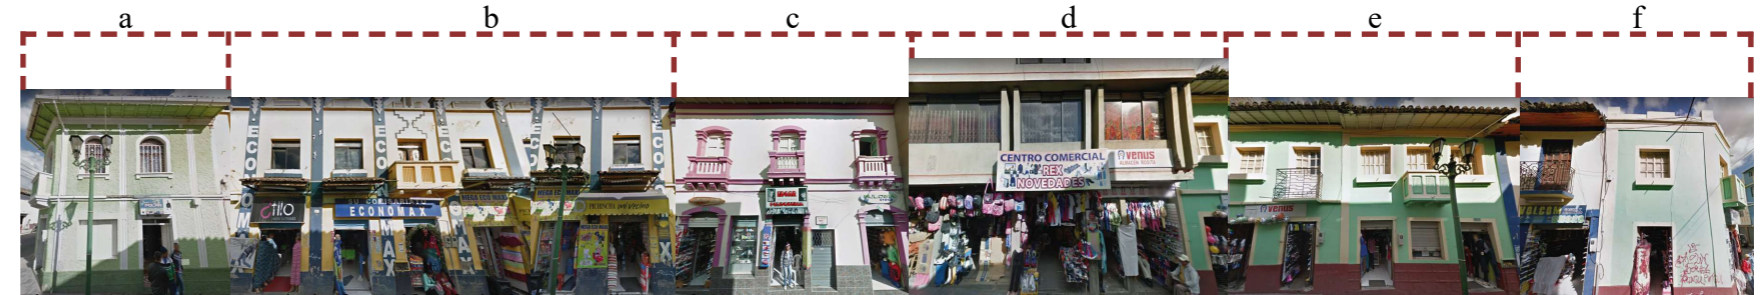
Relevamiento fotográfico fachada oeste calle Rocafuerte.
